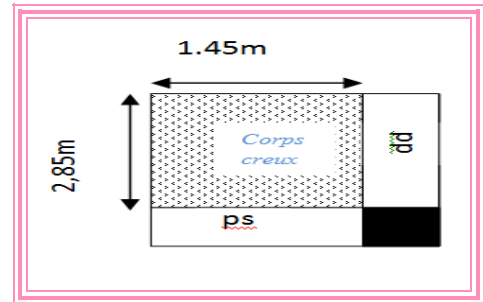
la surface afférente du poteau « C4 » de la terrasse accessible
